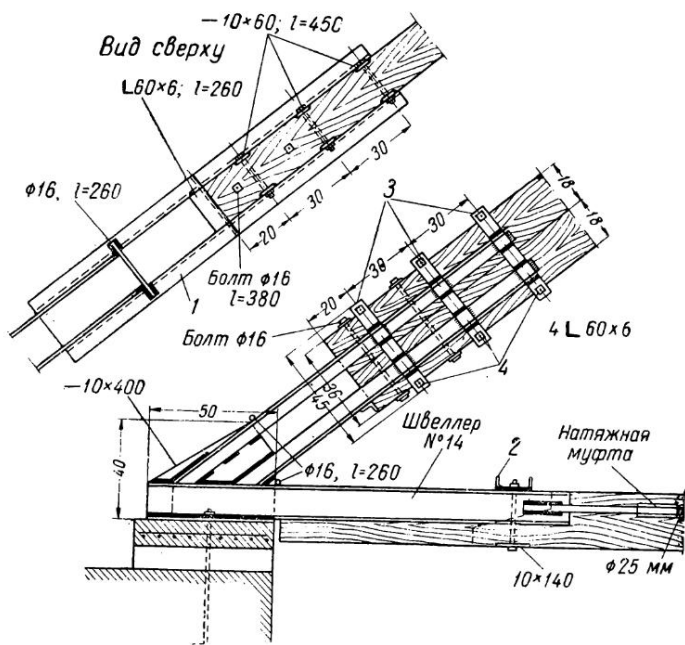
Протезирование узлов деревянных полигональных ферм.
